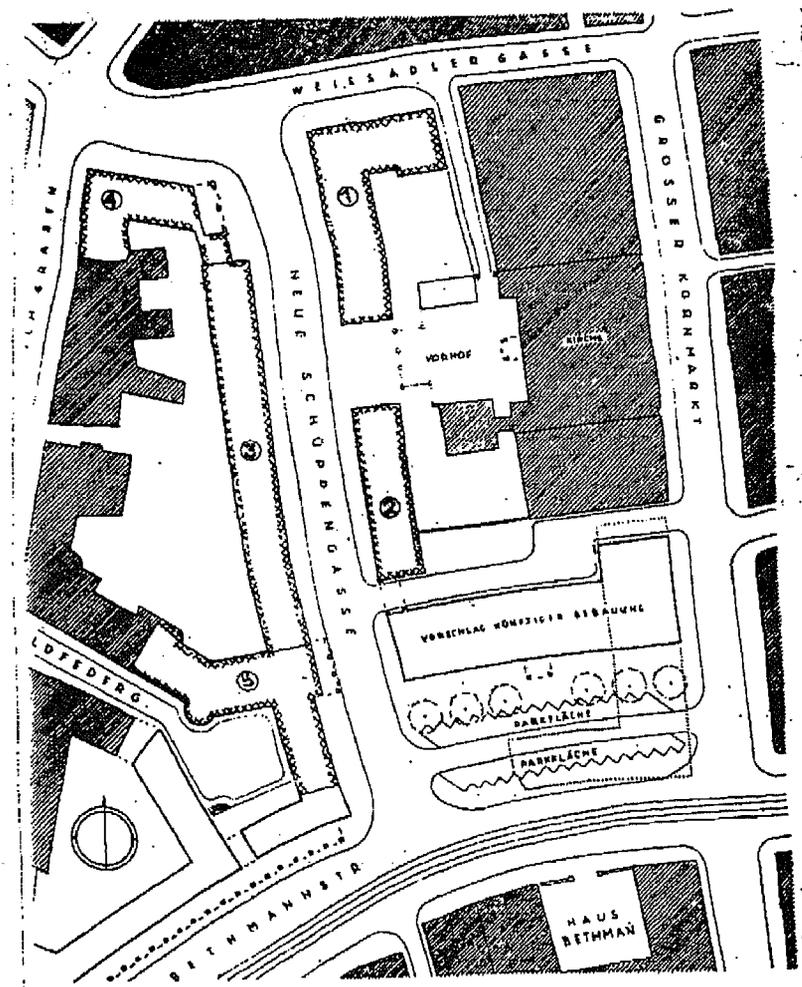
Bebauungsplan für den Sanierungsblock XVII
